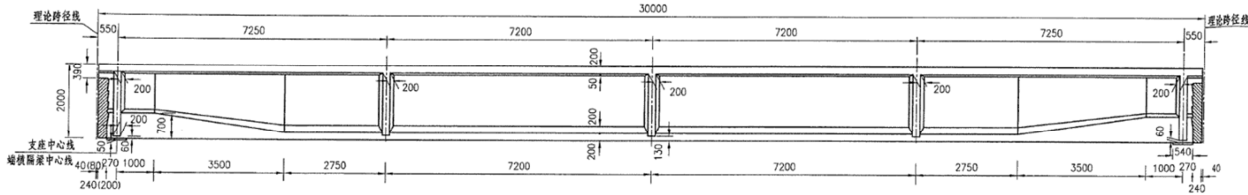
钟家湾大桥T梁立面布置图（单位：mm）。
